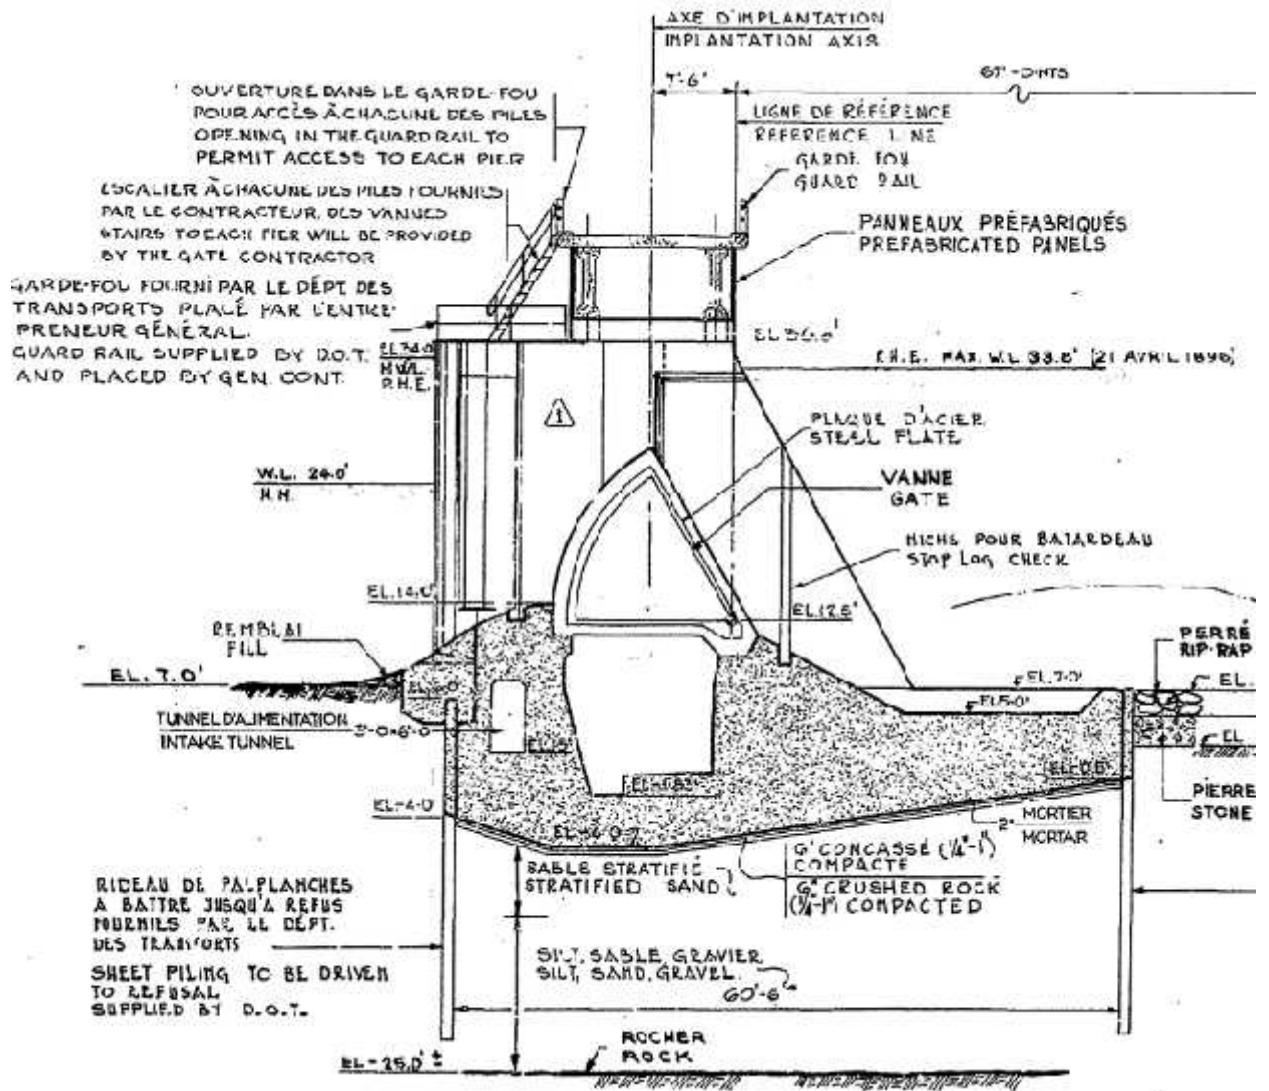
Coupe transversale du barrage de Saint-Ours.
